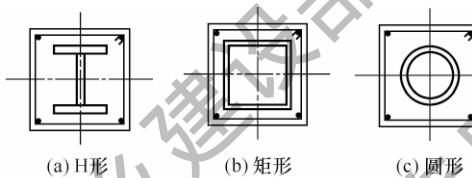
钢-混凝土组合结构中钢构件的形状
